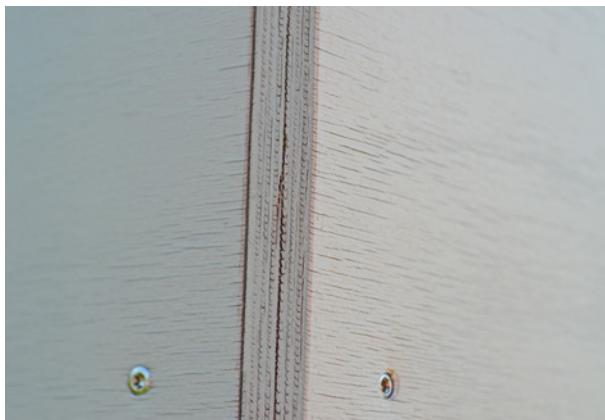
■ Rissbildung und sichtbare Furnierlagen an der Plattenkante
